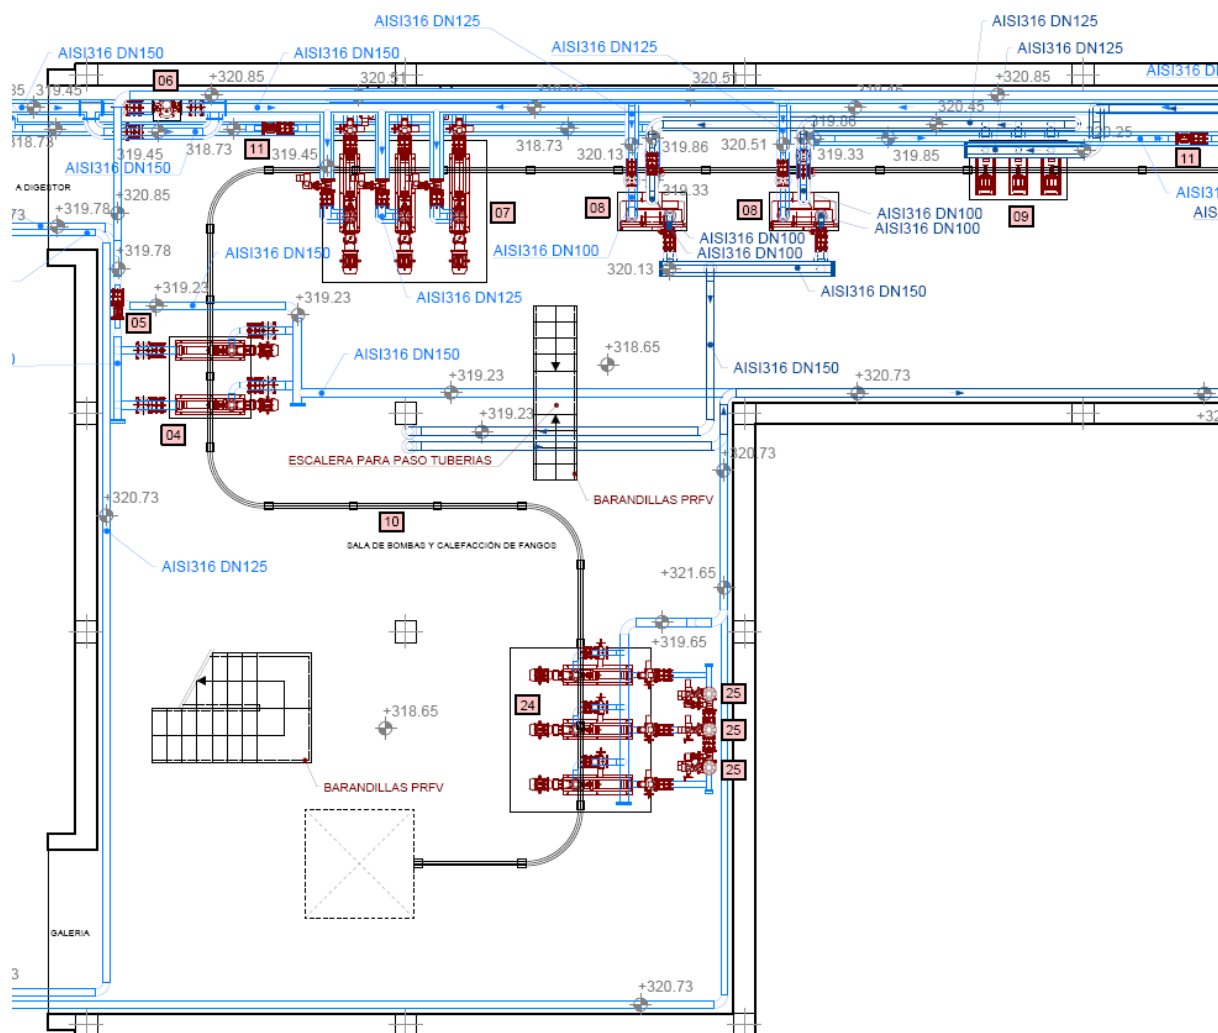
Planta general de situación de los equipos de bombeo y calefacción de fangos
